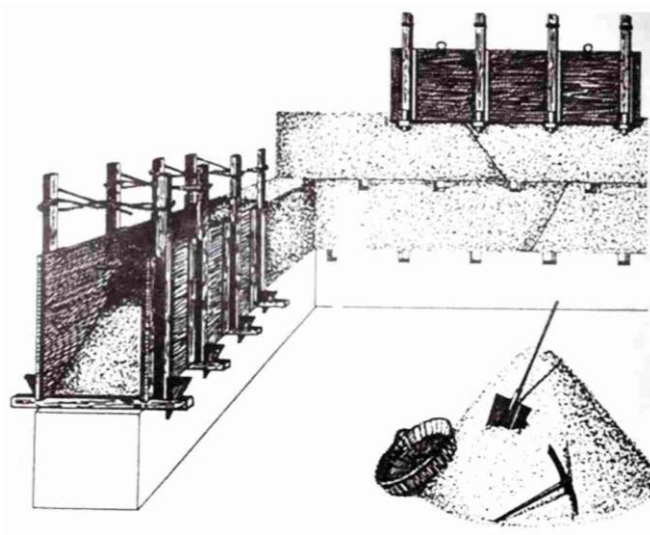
Elementos básicos para la construcción de un muro con tapia pisada. Fuente: (Sena.2009)
